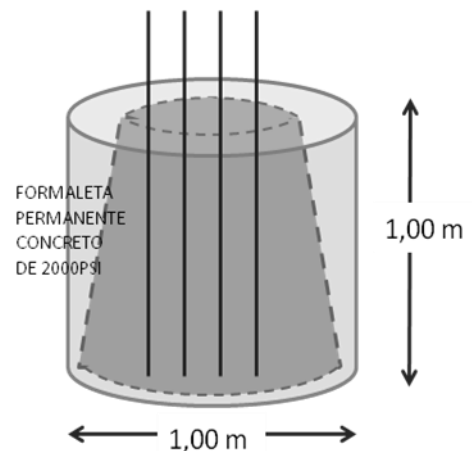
Módulos utilizados para la construcción de pilotes sección central Muro del PR 91+0500
